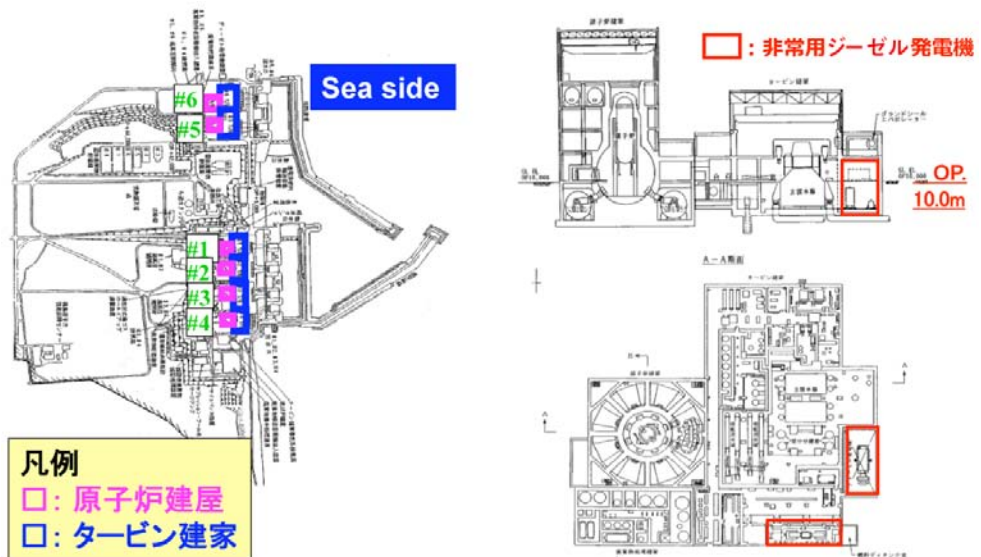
福島第一原子力発電所敷地と原子炉・タービン建屋の断面及び平面図
